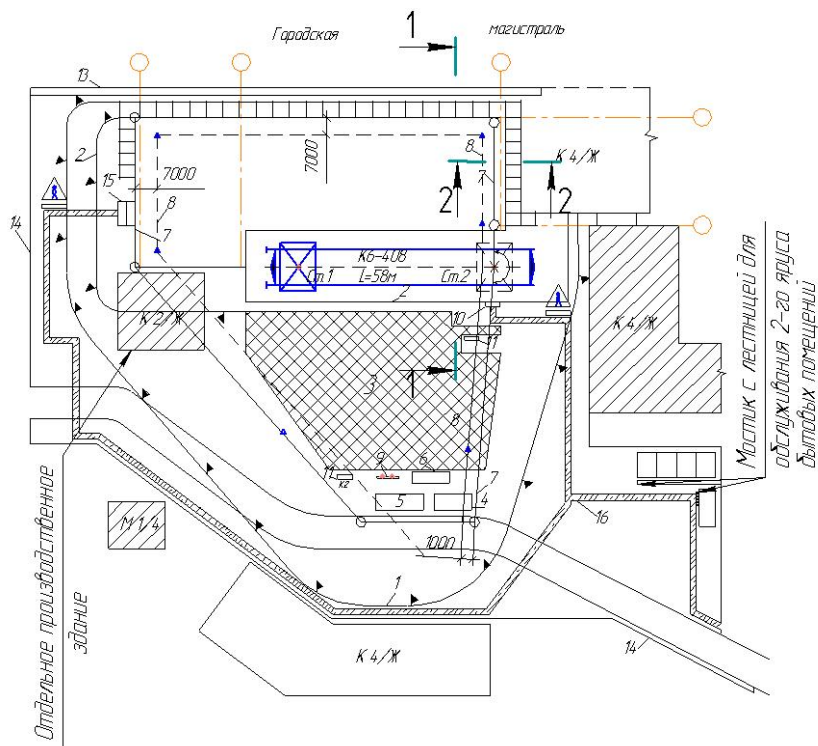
Возведение многоэтажного здания, примыкающего к более низкому жилому дому и выходящего на магистраль с интенсивным движением транспорта: 1 – граница опасной зоны от действия крана; 2 – граница опасной зоны строящегося здания; 3 – зона складирования грузов; 4 – площадка приема раствора и бетонной смеси; 5 – стоянка транспорта под разгрузкой; 6 – место хранения грузозахватных приспособлений и тары; 7 – линия ограничения зоны обслуживания; 8 – линия предупреждения об ограничении зоны обслуживания; 9 – стенд схем строповок; 10 – шкаф электропитания; 11 – контрольный груз; 12 – ограждение крановых путей; 13 – временное ограждение с козырьком; 14 – временное ограждение; 15 – навес над входом в здание; 16 – пешеходная дорожка; 17 – знак, предупреждающий о работе крана
